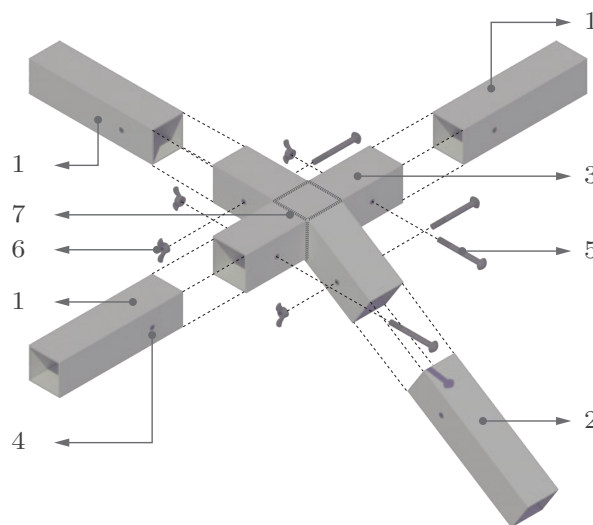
Detalle de la conexión entre cubierta plana a inclinada de 4 vías (3 a 90° y 1 a 32.50°) del habitáculo Modular Emergency Plant. Fuente y elaboración: Autores.
